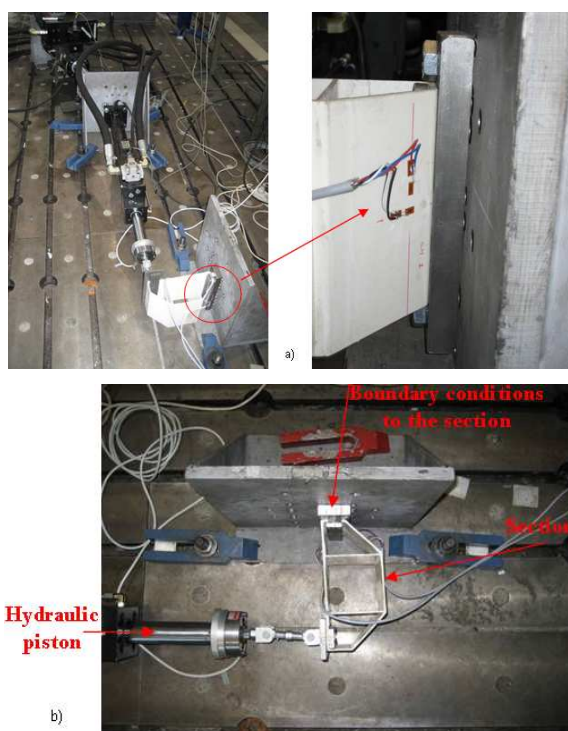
Ensaio à fadiga de um perfil pultrudido. a) colocação de extensómetros
